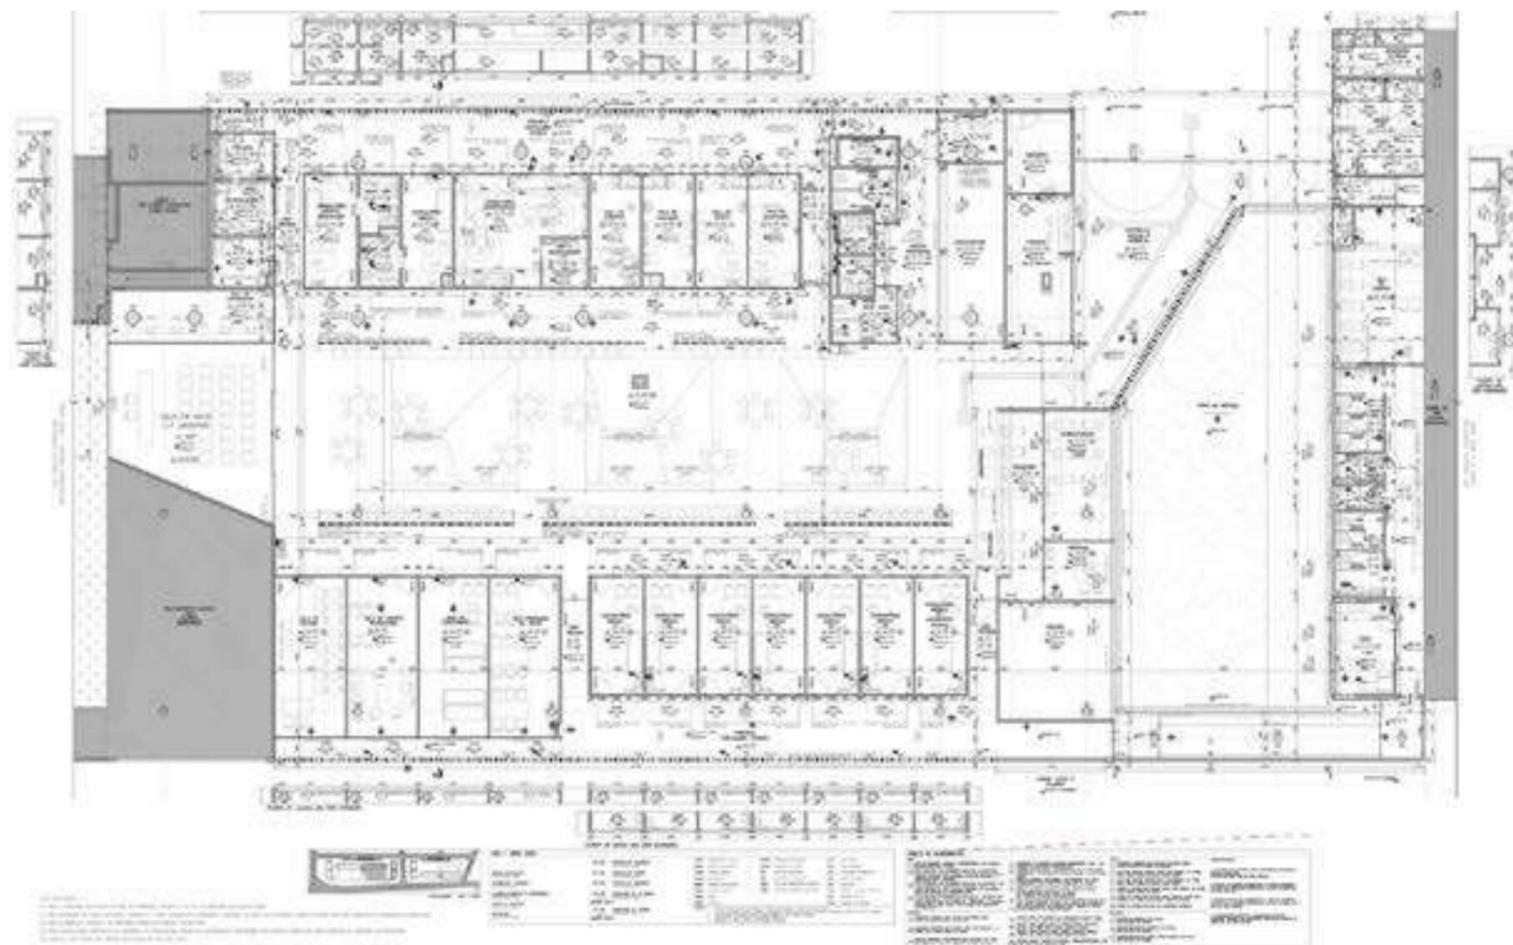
Pavimento Superior. Fonte. Archdaily/Jirau Arquitetura
